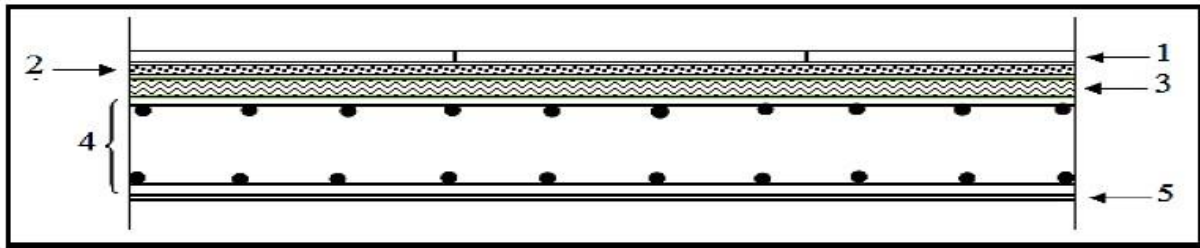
d: Composants d'un balcon (dalle pleine).
